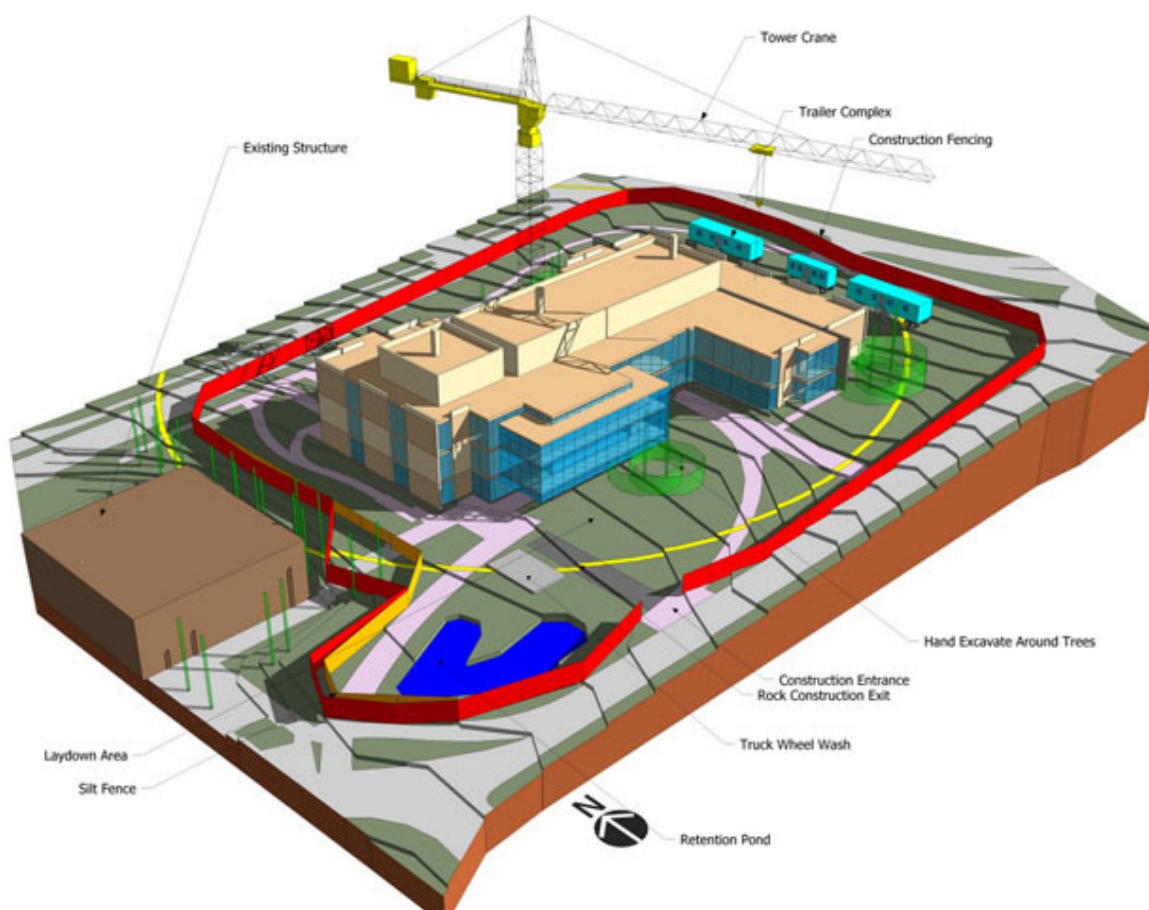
Layout di cantiere (Google Sketch Up construction case studies, 2012)
